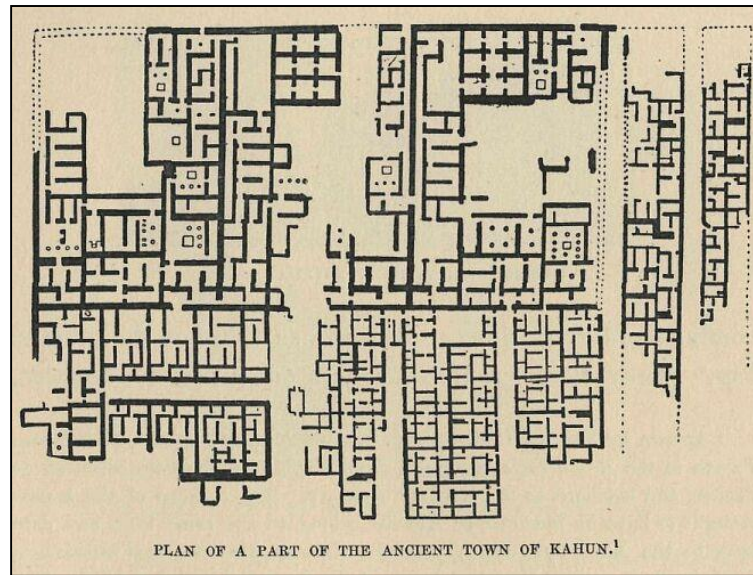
/ la cité ouvrière de KAHUN, première ville sur un plan déterminé, l'ancienne Egypt.
